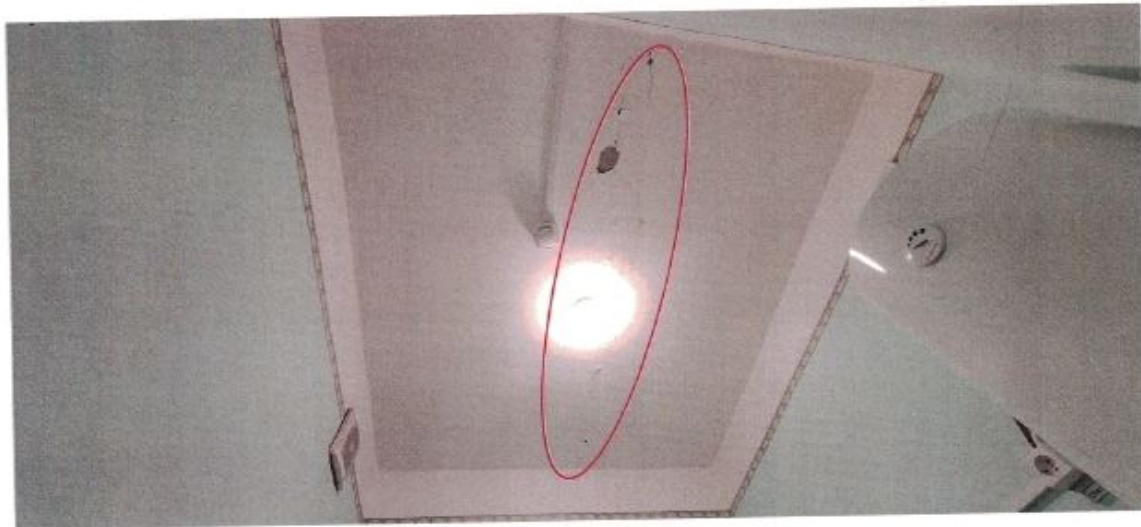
Трещины и отслоение межплитных швов перекрытия
